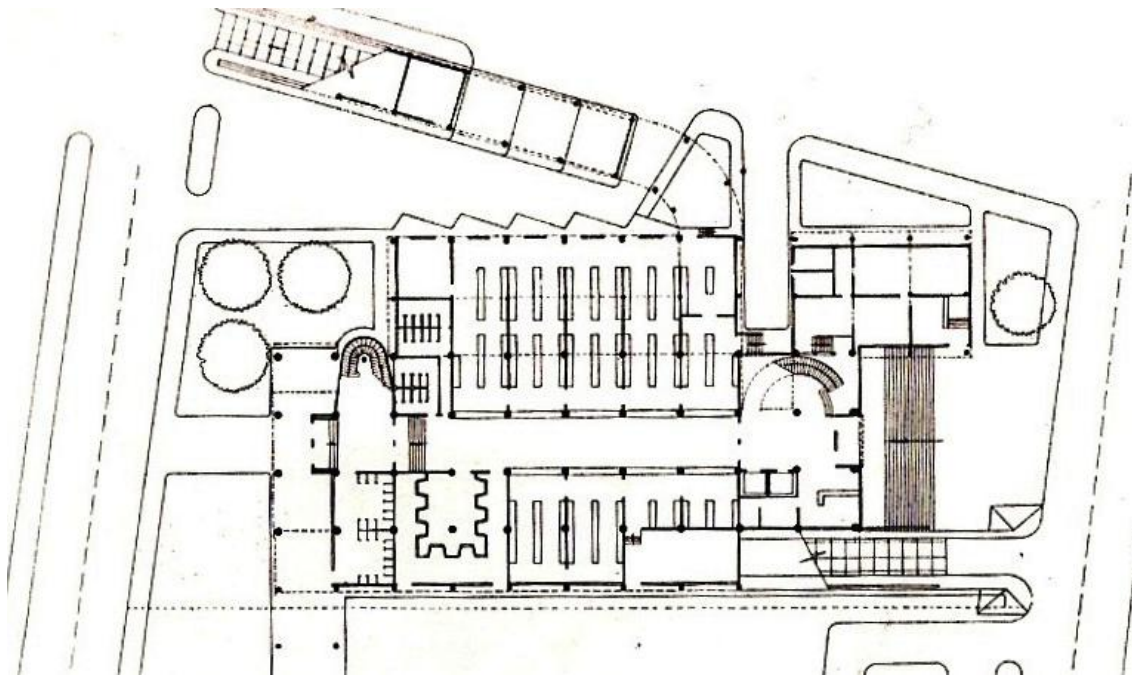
Grundriss des Erdgeschosses, Postamt.
